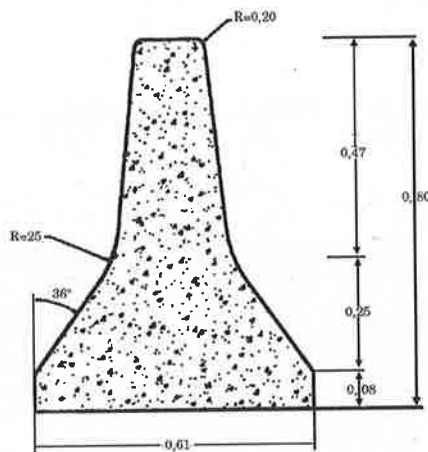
Muro de hormigón prefabricado o fundido *in situ* por la técnica de moldes deslizantes. Tipo *New Jersey
